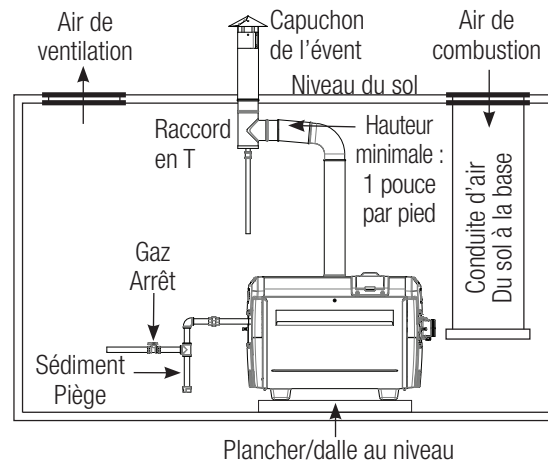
Installation avec air provenant de l'extérieur du bâtiment
